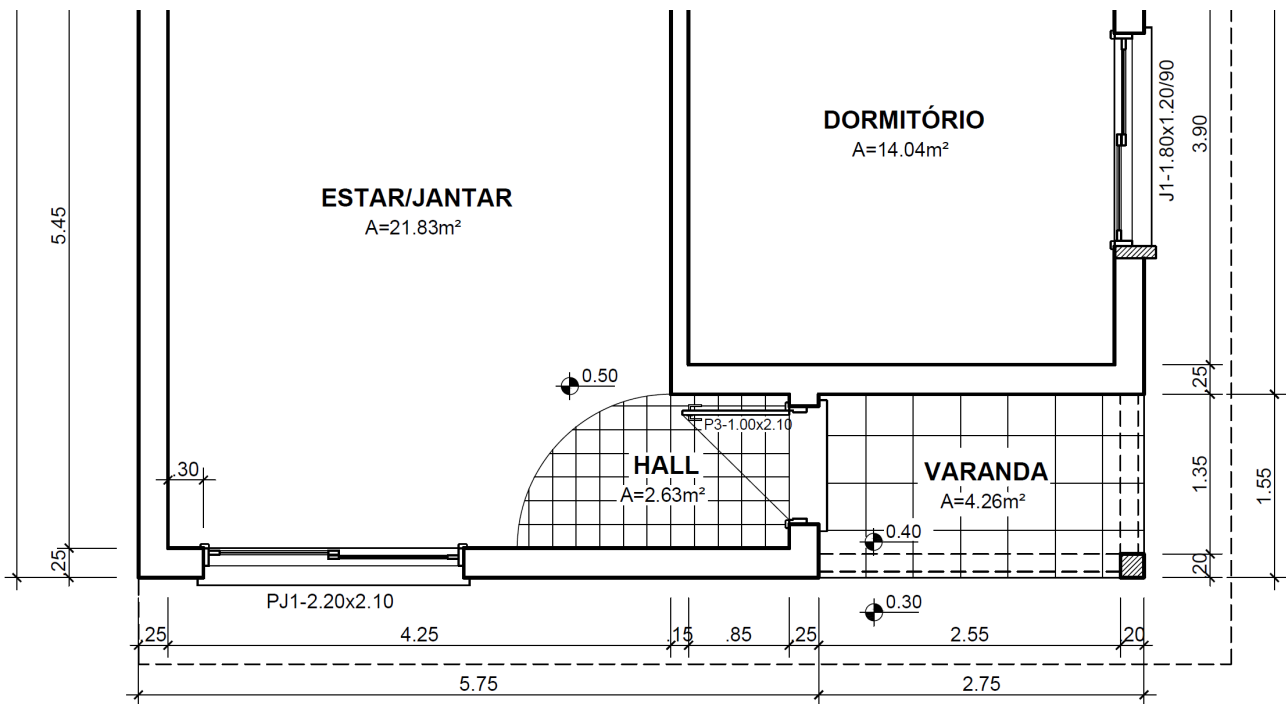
Etapas de representação da planta baixa: cotas e níveis. Fonte: Autor
